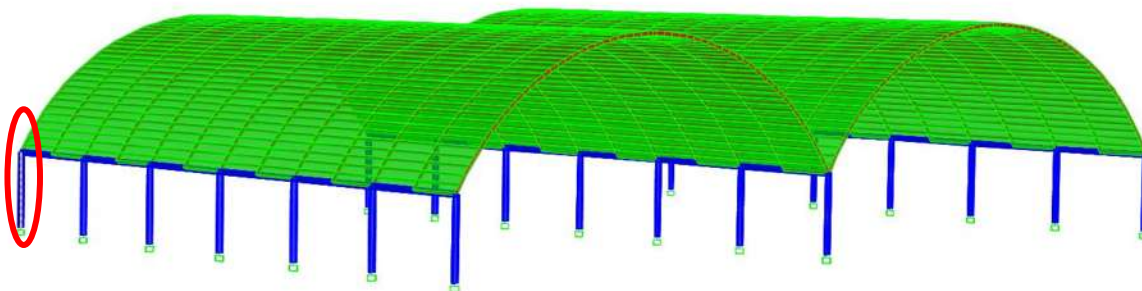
(a) Columna crítica en flexocompresión
